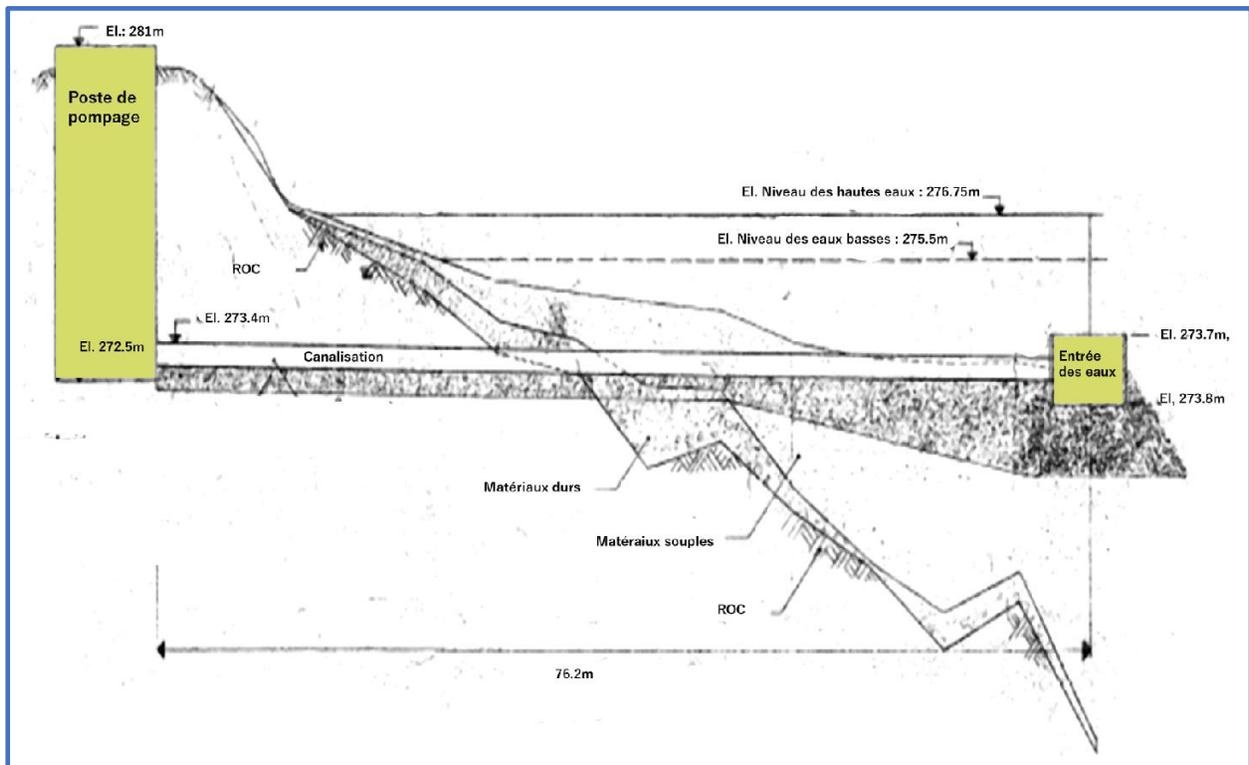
Plan de la prise d'eau potable (entrée des eaux)
